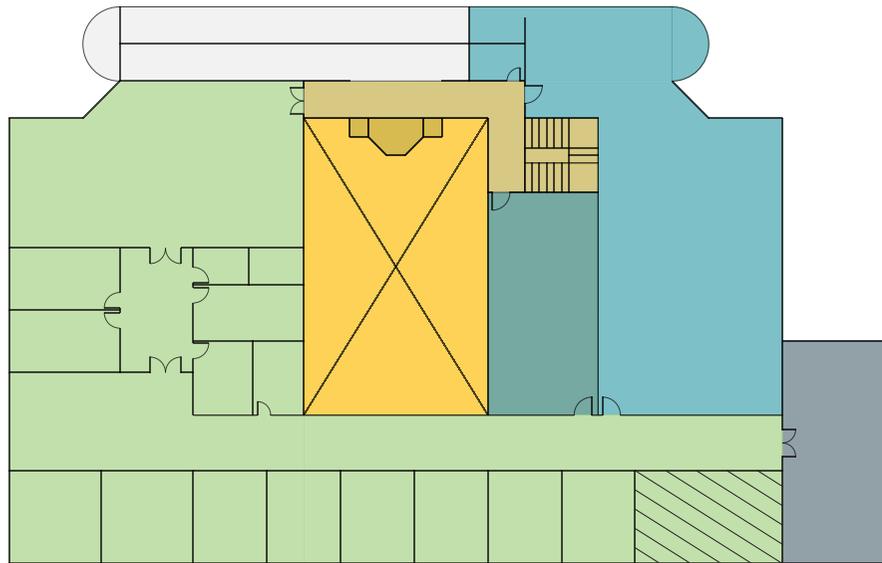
PLANTA ESQUEMÁTICA PAV. TÉRREO
